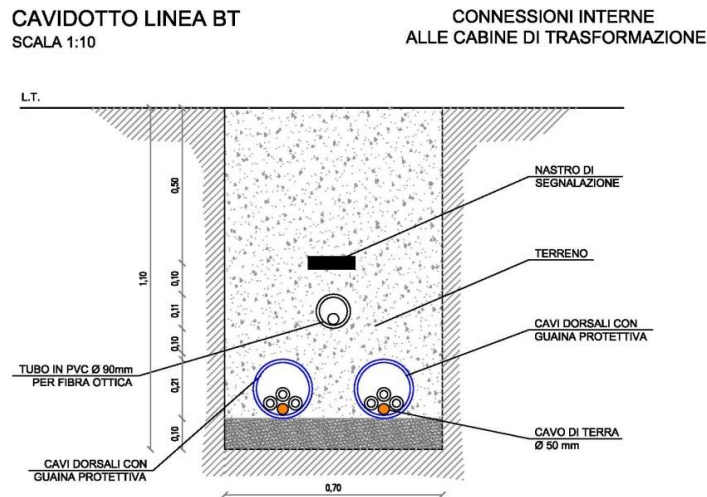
Sezione tipica di posa CEI 11-17 (cavidotto linea BT).
